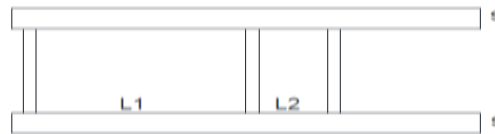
Vista del plano en elevación del Hotel Palermo
